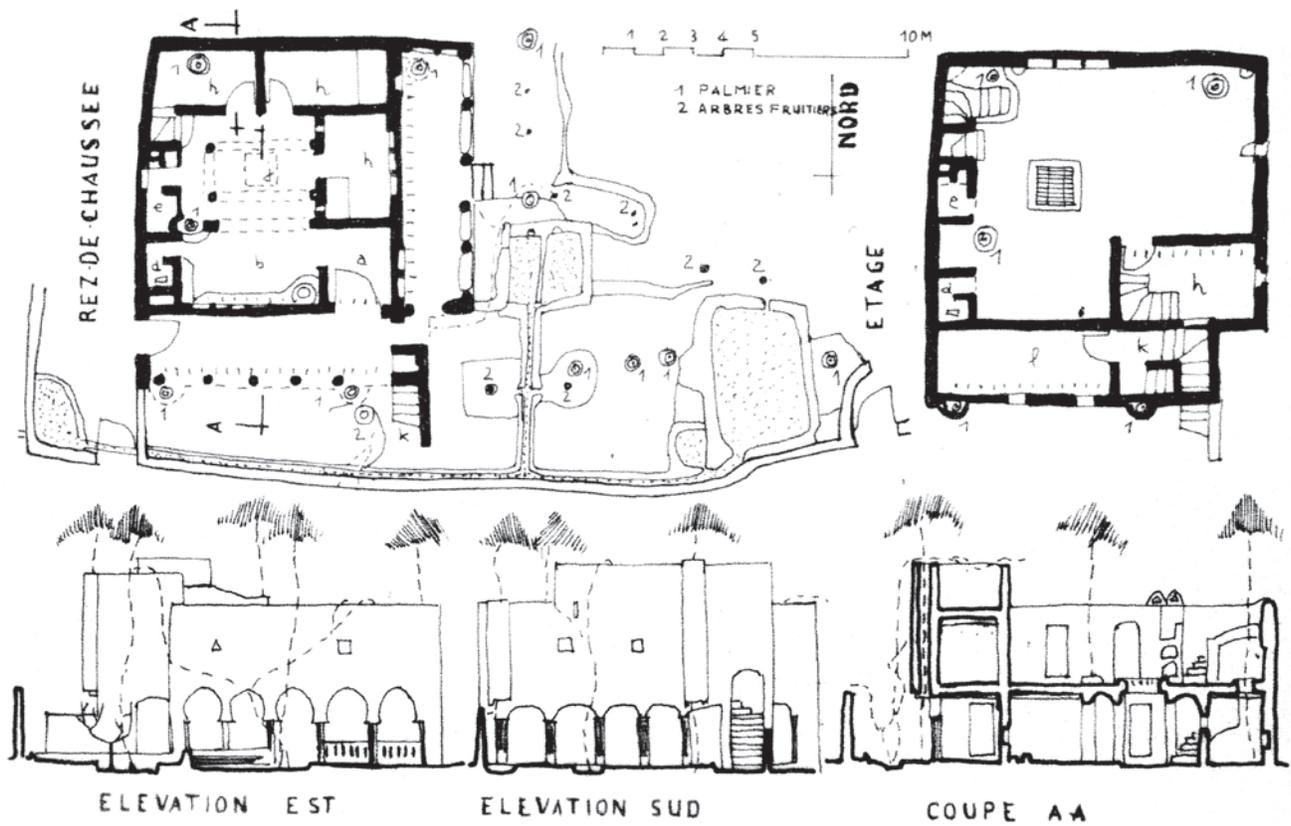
Planta, elevaciones y corte de una vivienda en el palmar de Beni-Isguen
